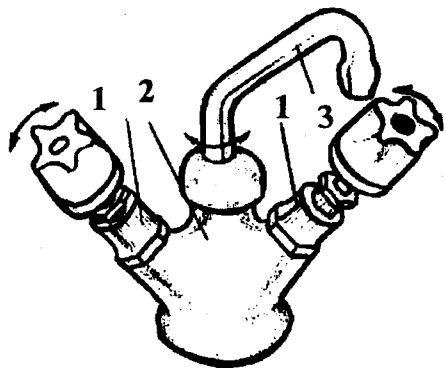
Смеситель: 1 — вентиляльная головка; 2 — корпус; 3 — водоизливная трубка
